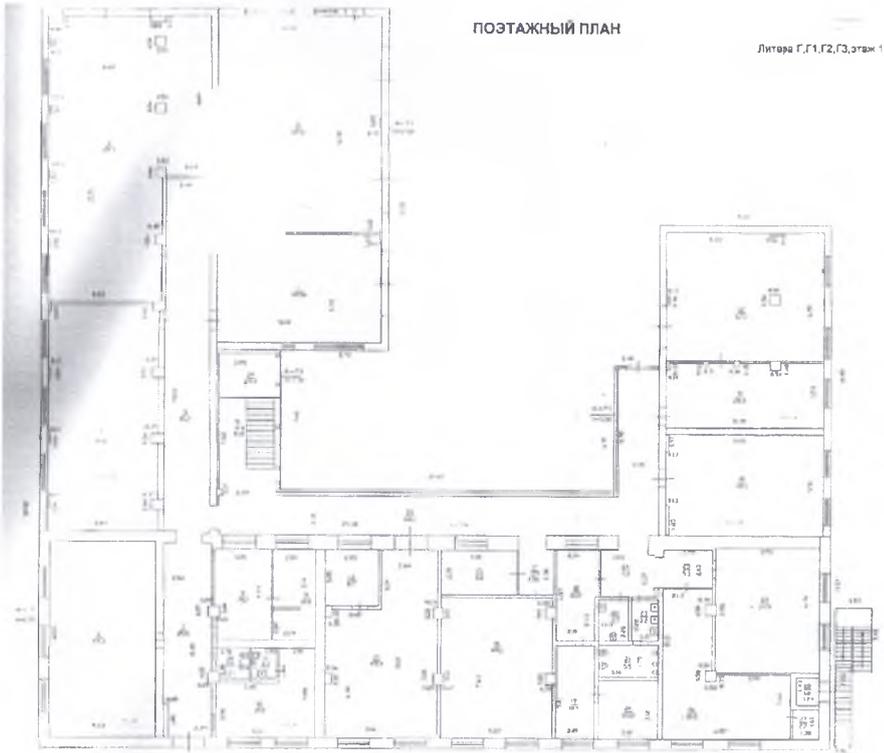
Планировка помещений учебно-лабораторного корпуса № 3
